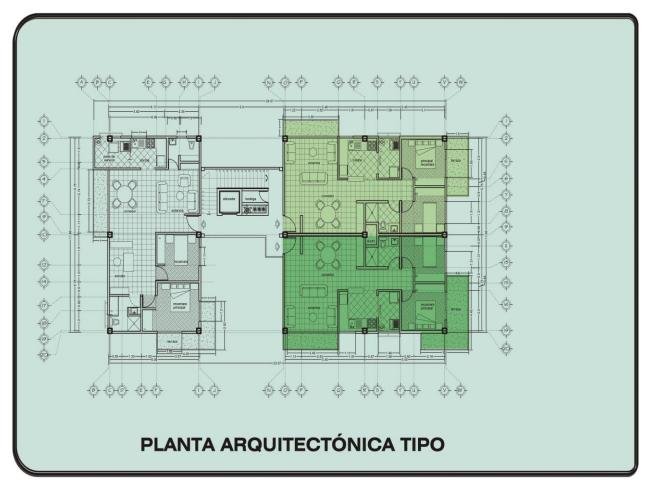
PLANTA ARQUITECTÓNICA DEPARTAMENTOS TIPO B
